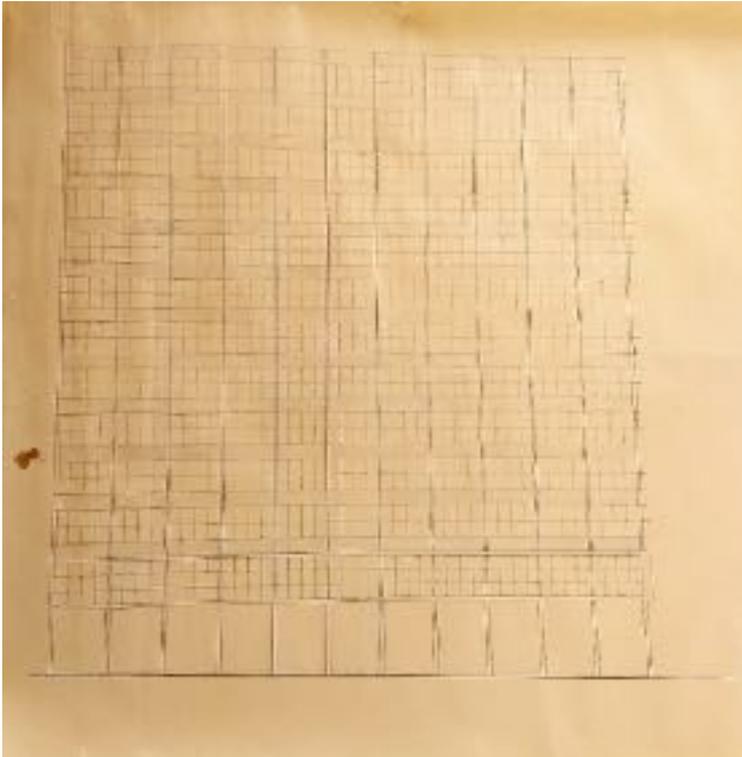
Fotografia do projeto original do Edifício Maria Joaquina. Fachada da Praça Alencastro. Autor da fotografia: Evillyn Biazatti.
